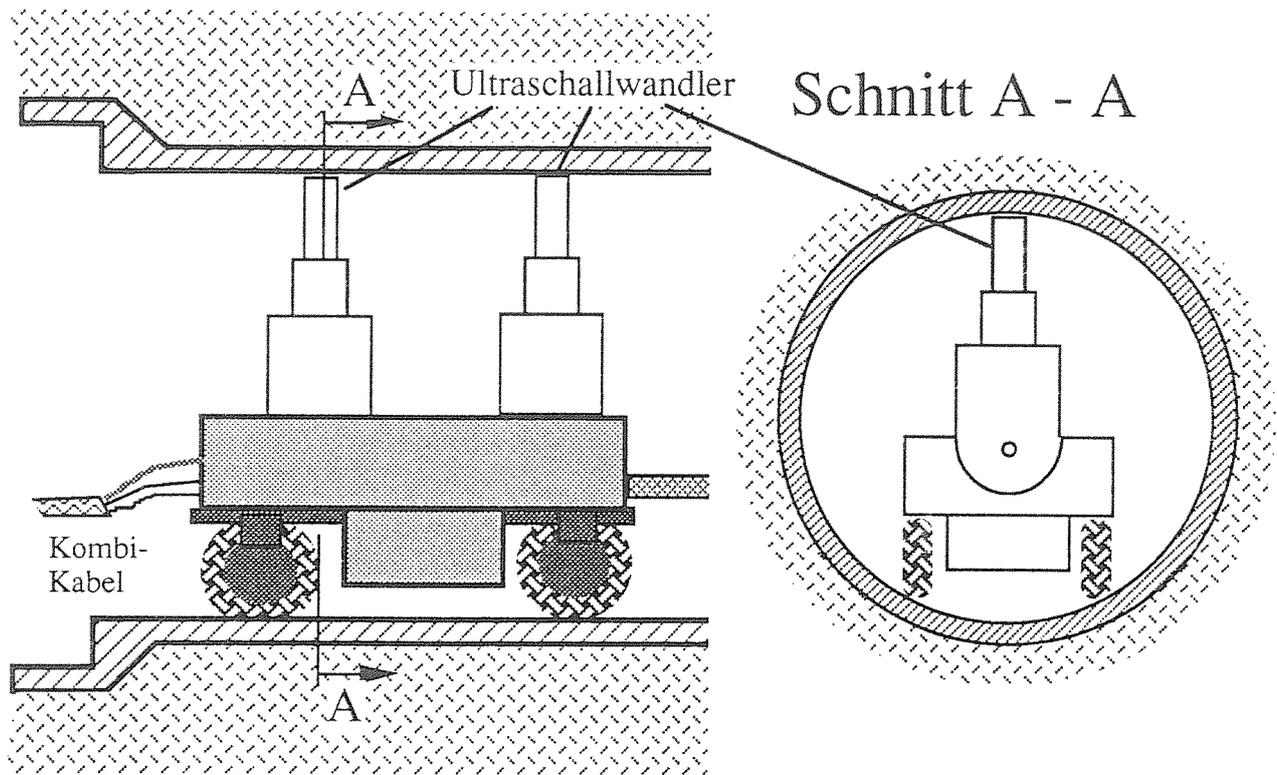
Prototyp für Ultraschallmessungen im Kanal
